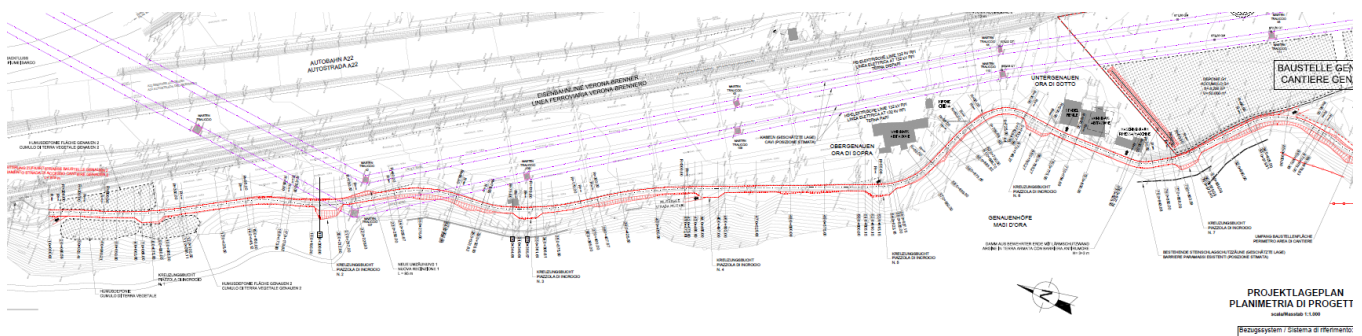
Lageplan Zufahrtstrasse Baustelle Genauen 2
